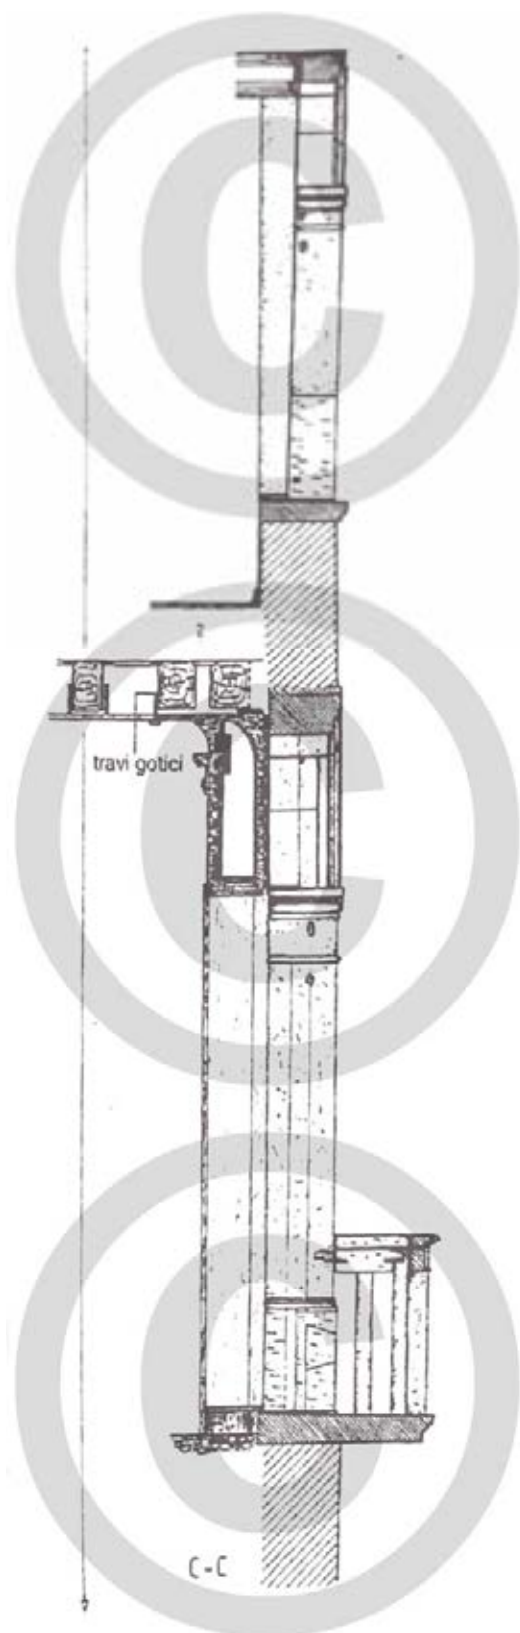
Sección C-C' de la fachada de la Corte Remer. (Schuller)
